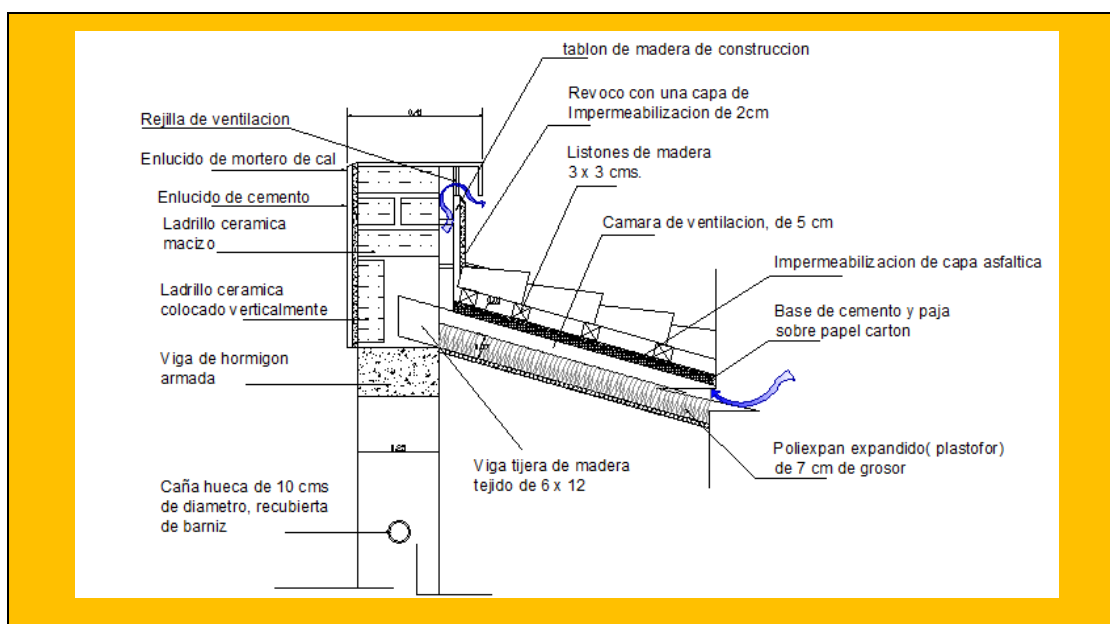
Detalle constructivo de la cámara ventilada de cubierta
